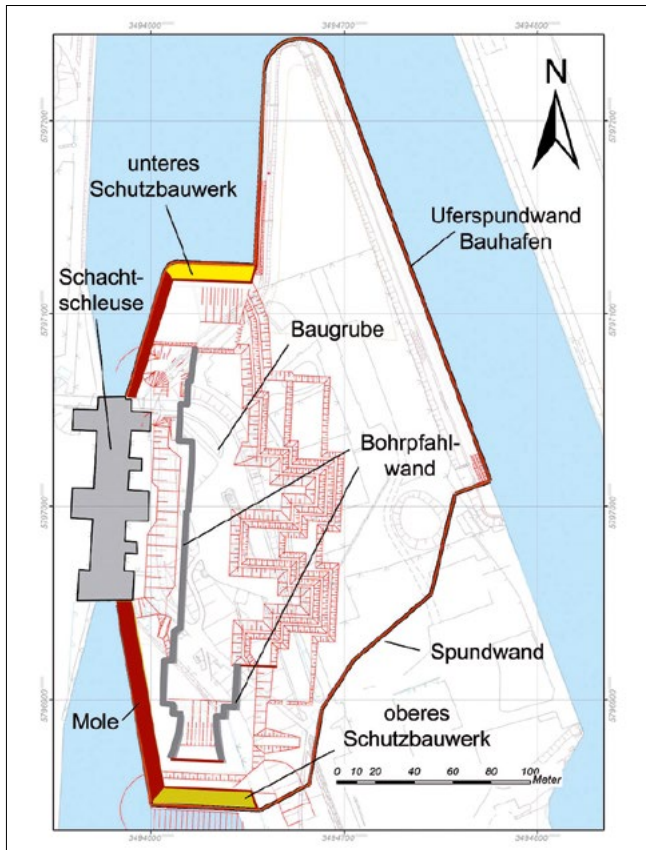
Lageplan der Baugrube mit Baugrubenumschließung
